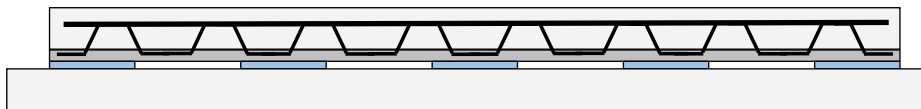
Schwimmende Platte auf Streifenlagerung
